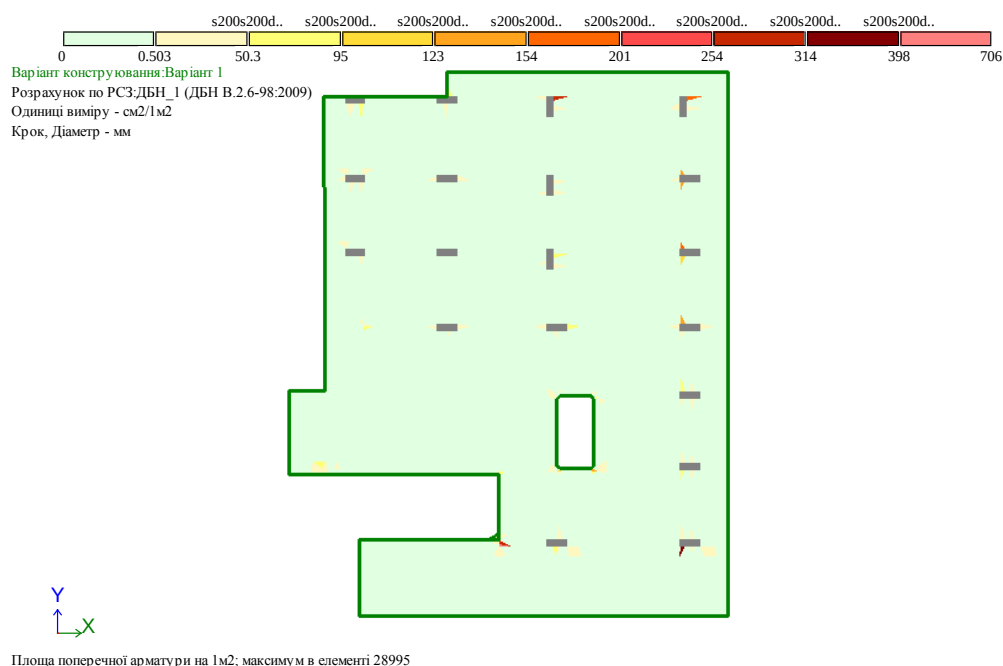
Армування плити перекриття типового поверху половини будівлі (поперечна арматура)
